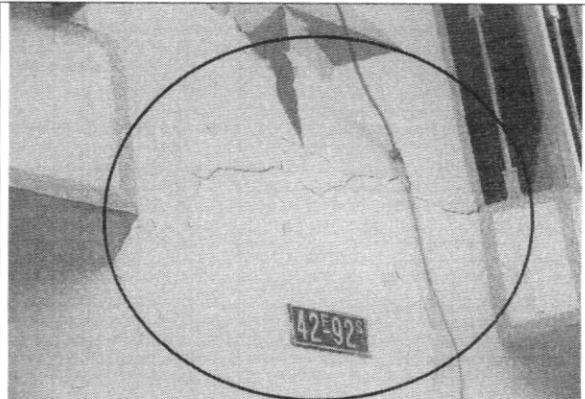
Grieta en muro de fachada, zona central segundo piso
